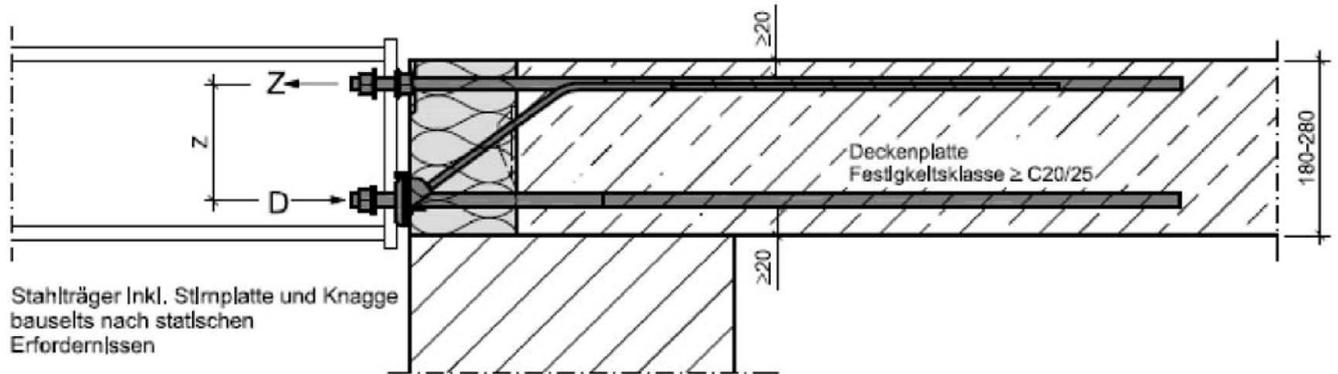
Schöck Isokorb® XT Typ SK-MM1-VV1
